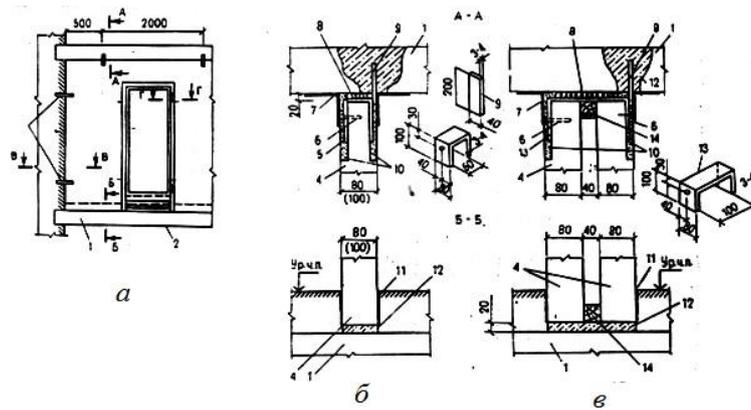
Перегородки из гипсобетонных панелей и их крепления к несущим конструкциям:
